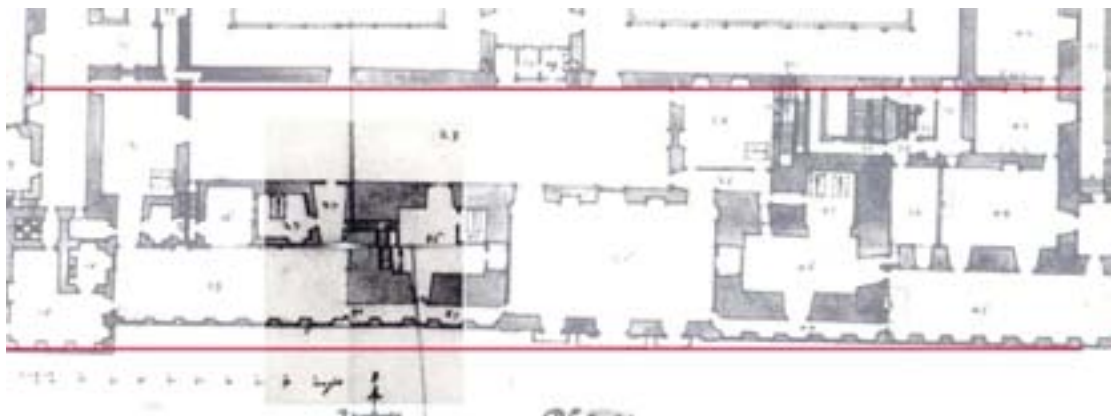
JUAN GÓMEZ DE MORA. 1626 Detalle Planta principal del Alcázar.
